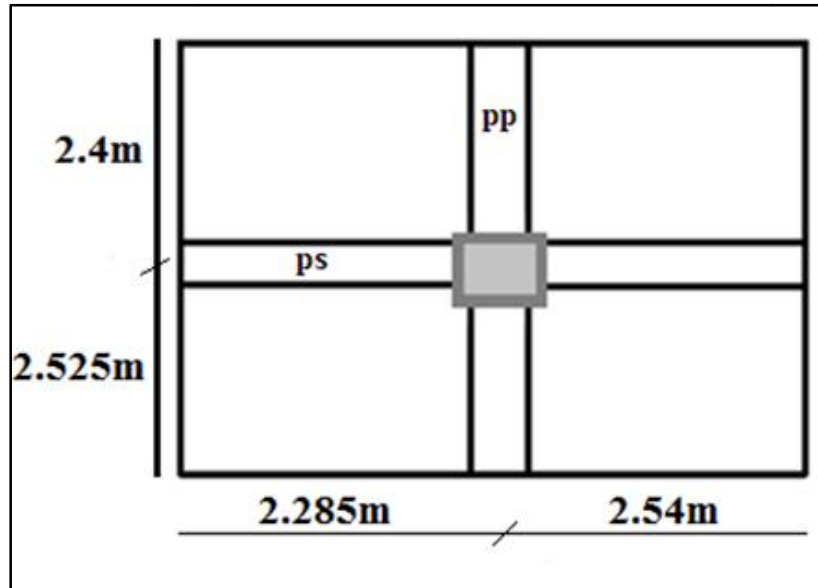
Schéma des sections de calcul des poteaux (Coupe en élévation).
